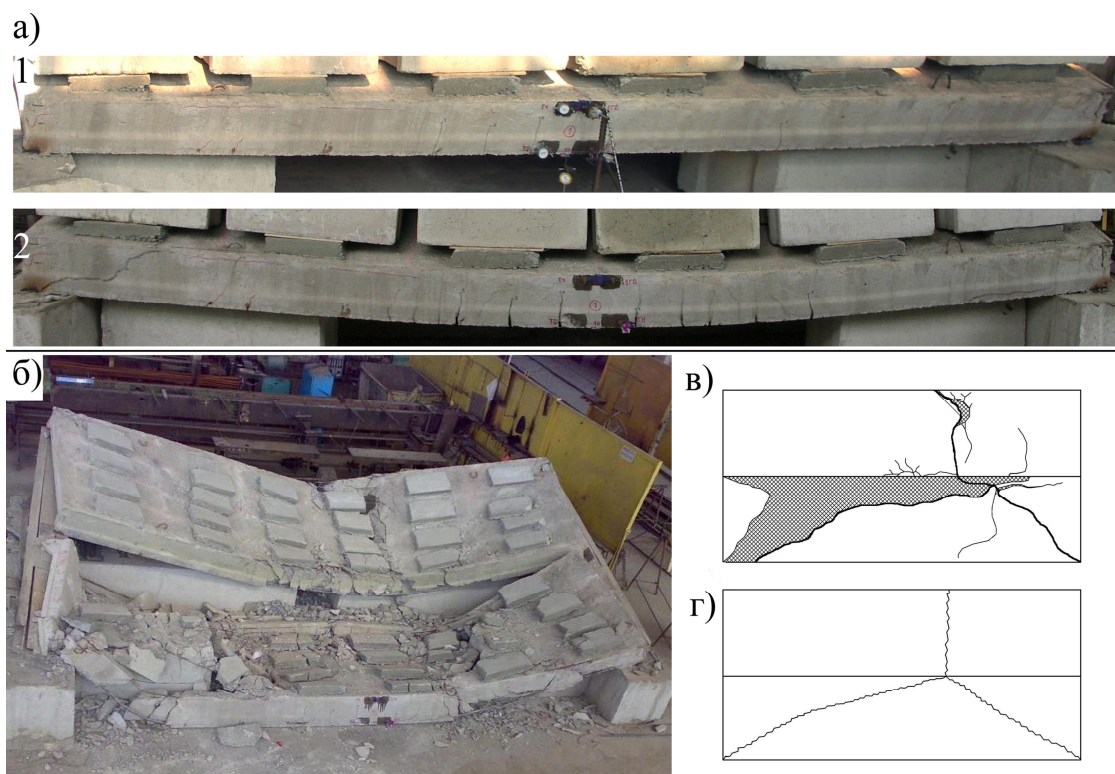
Общий вид трещинообразования в продольном ребре нижней плиты фрагмента (а); общий вид разрушения фрагмента складчатого покрытия (б); схемы разрушения фрагмента: опытная (в) и расчетная (г)
